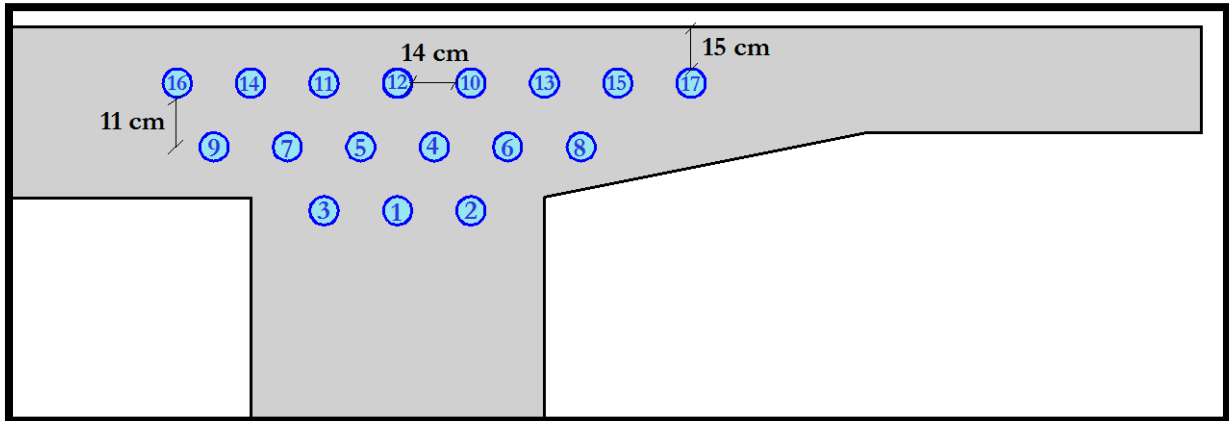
Position et enrobage des câbles au niveau du voussoir sur pile.
